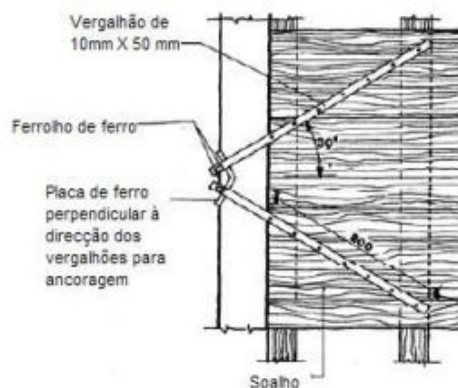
Utilização de vergalhões de aço na ligação pavimento-parede em planta [12]
